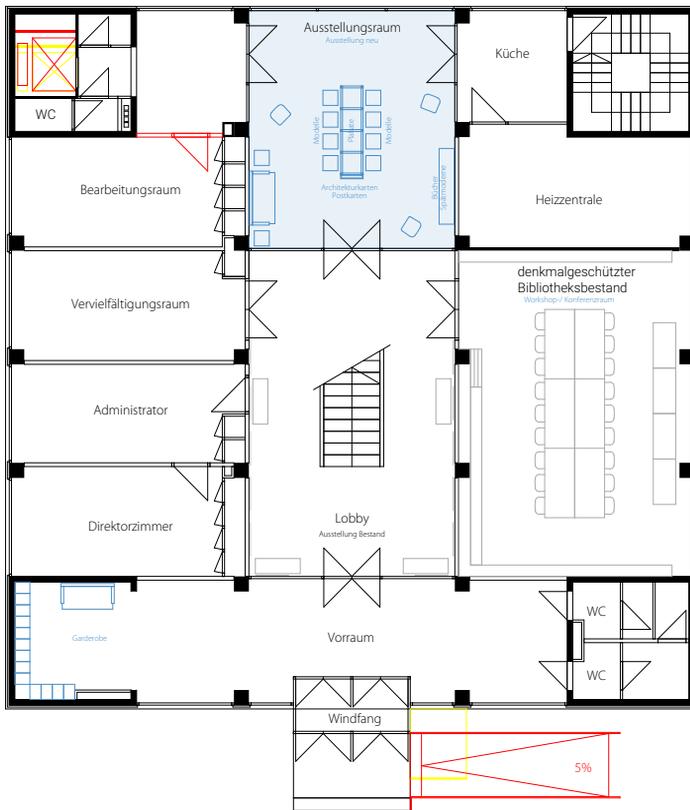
| Grundriss EG, Ausstellungskonzept
